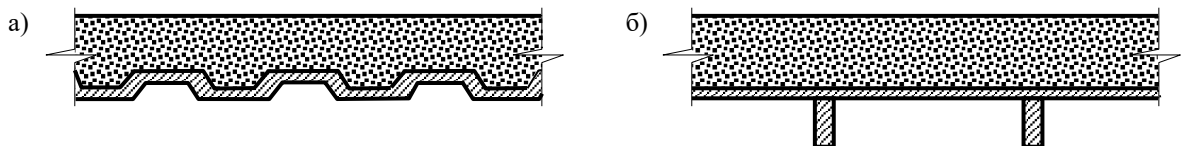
Поперечні перерізи сталезалізобетонних плит: а) по сталевому профнастилу; б) по сталевій ортотропній плиті
